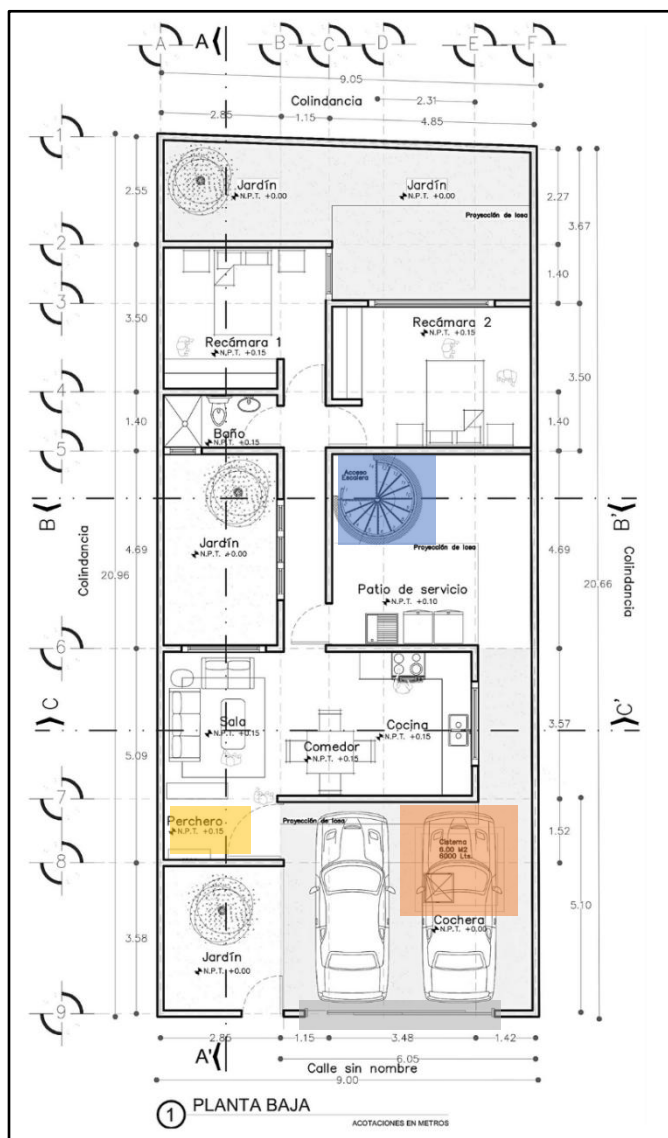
Plano arquitectónico Planta Baja primera propuesta. Elaboración propia. (YPHC 2025)
